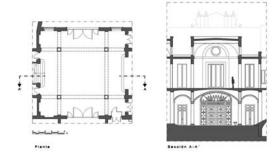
Planta y sección del vestíbulo en el que se materializa la técnica de las bóvedas tabicadas
